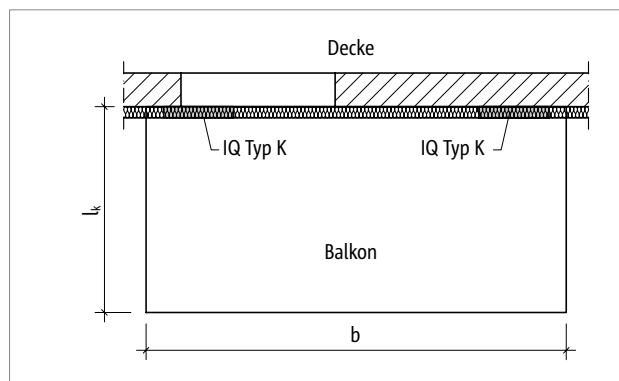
Schöck Isokorb® IQ Typ K: Grundriss
